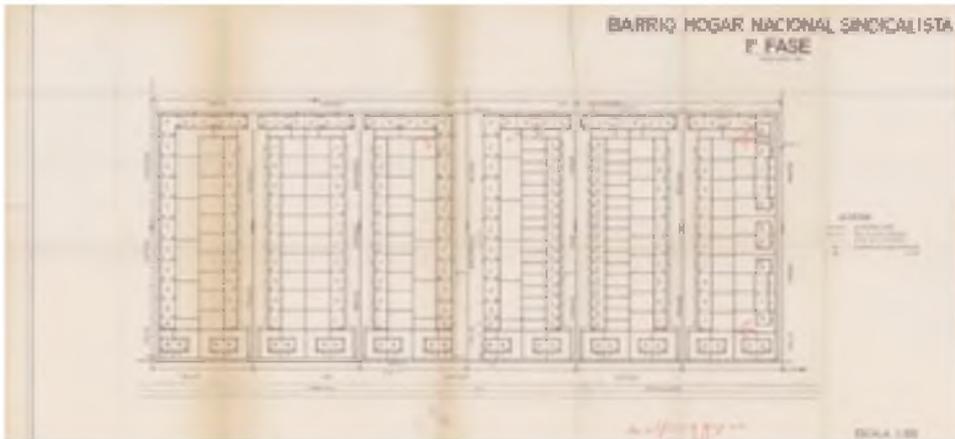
Grupo Barrio El Hogar Nacional Sindicalista. 1ª Fase: Planta de conjunto definitiva. Caja nº 48.
